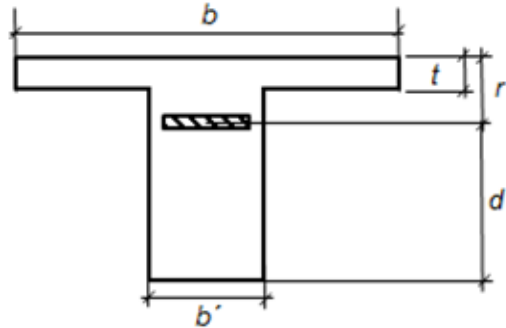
Viga "T" (contribución del acero a tensión de la losa)
